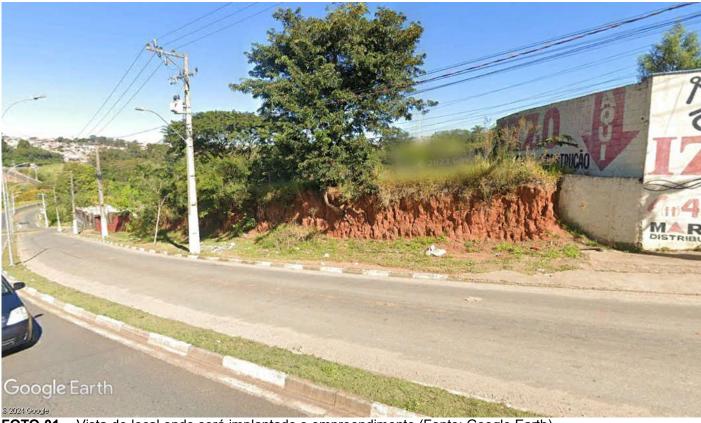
Vista do local onde será implantado o empreendimento (Fonte: Google Earth).
